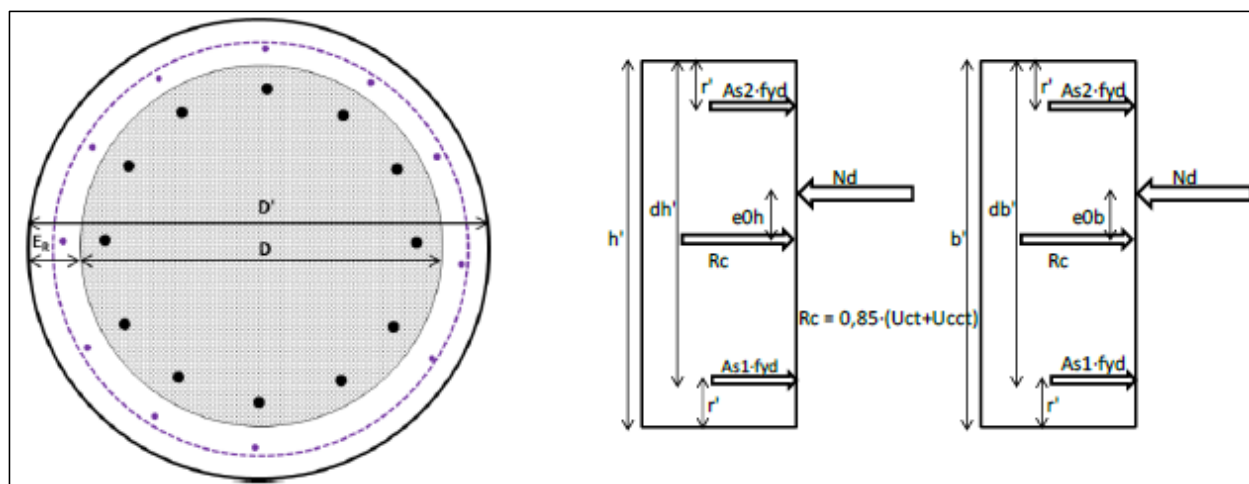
Sección de refuerzo de una columna circular con concreto reforzado. Fuente: Alonso Izquierdo, J. (2015)
